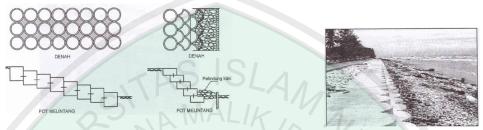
Revetment dan material beton bertulang precast Sumber : Triatmodjo
